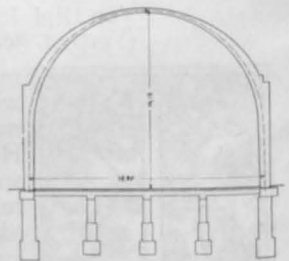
In Deutschland ausgeführte Eisenbeton-Hallenbauten über 16 m Stützweite.
